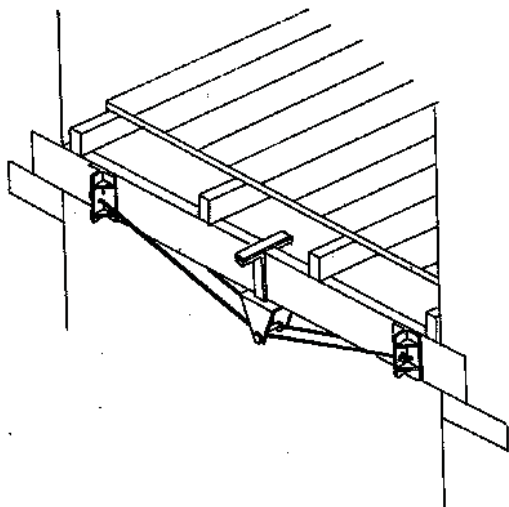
Aplicação de pré-esforço na reabilitação de pavimentos de madeira.
